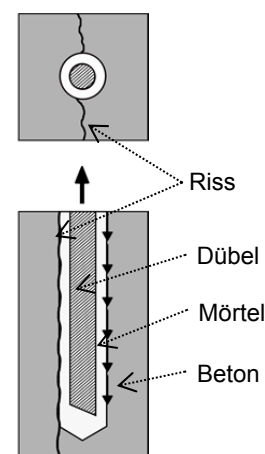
Störung des Verbunds zwischen Mörtel und Beton durch Riss (nach Eligehausen, Mallée (2000))
